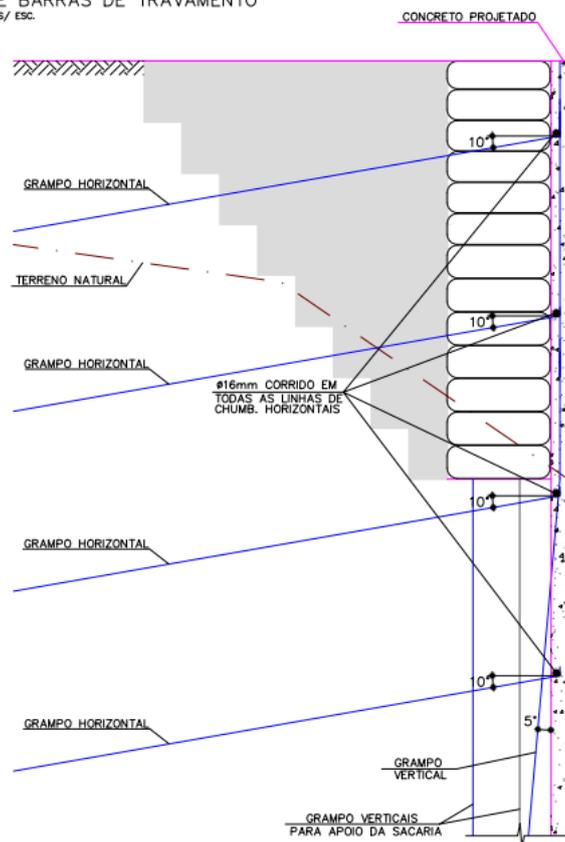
Detalhe de colocação dos grampos e travamento da sacaria
